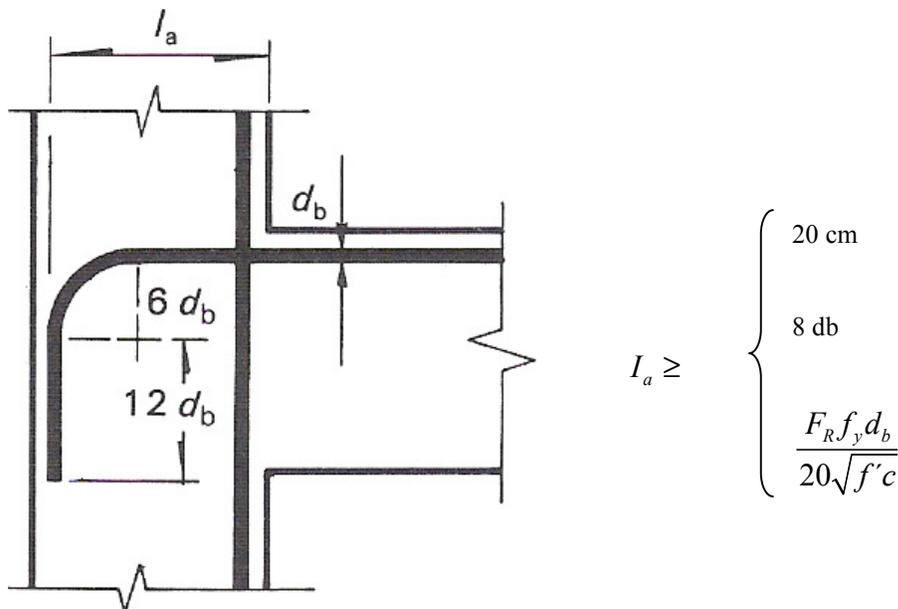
Anclaje de barras longitudinales de las vigas en columnas externas.
